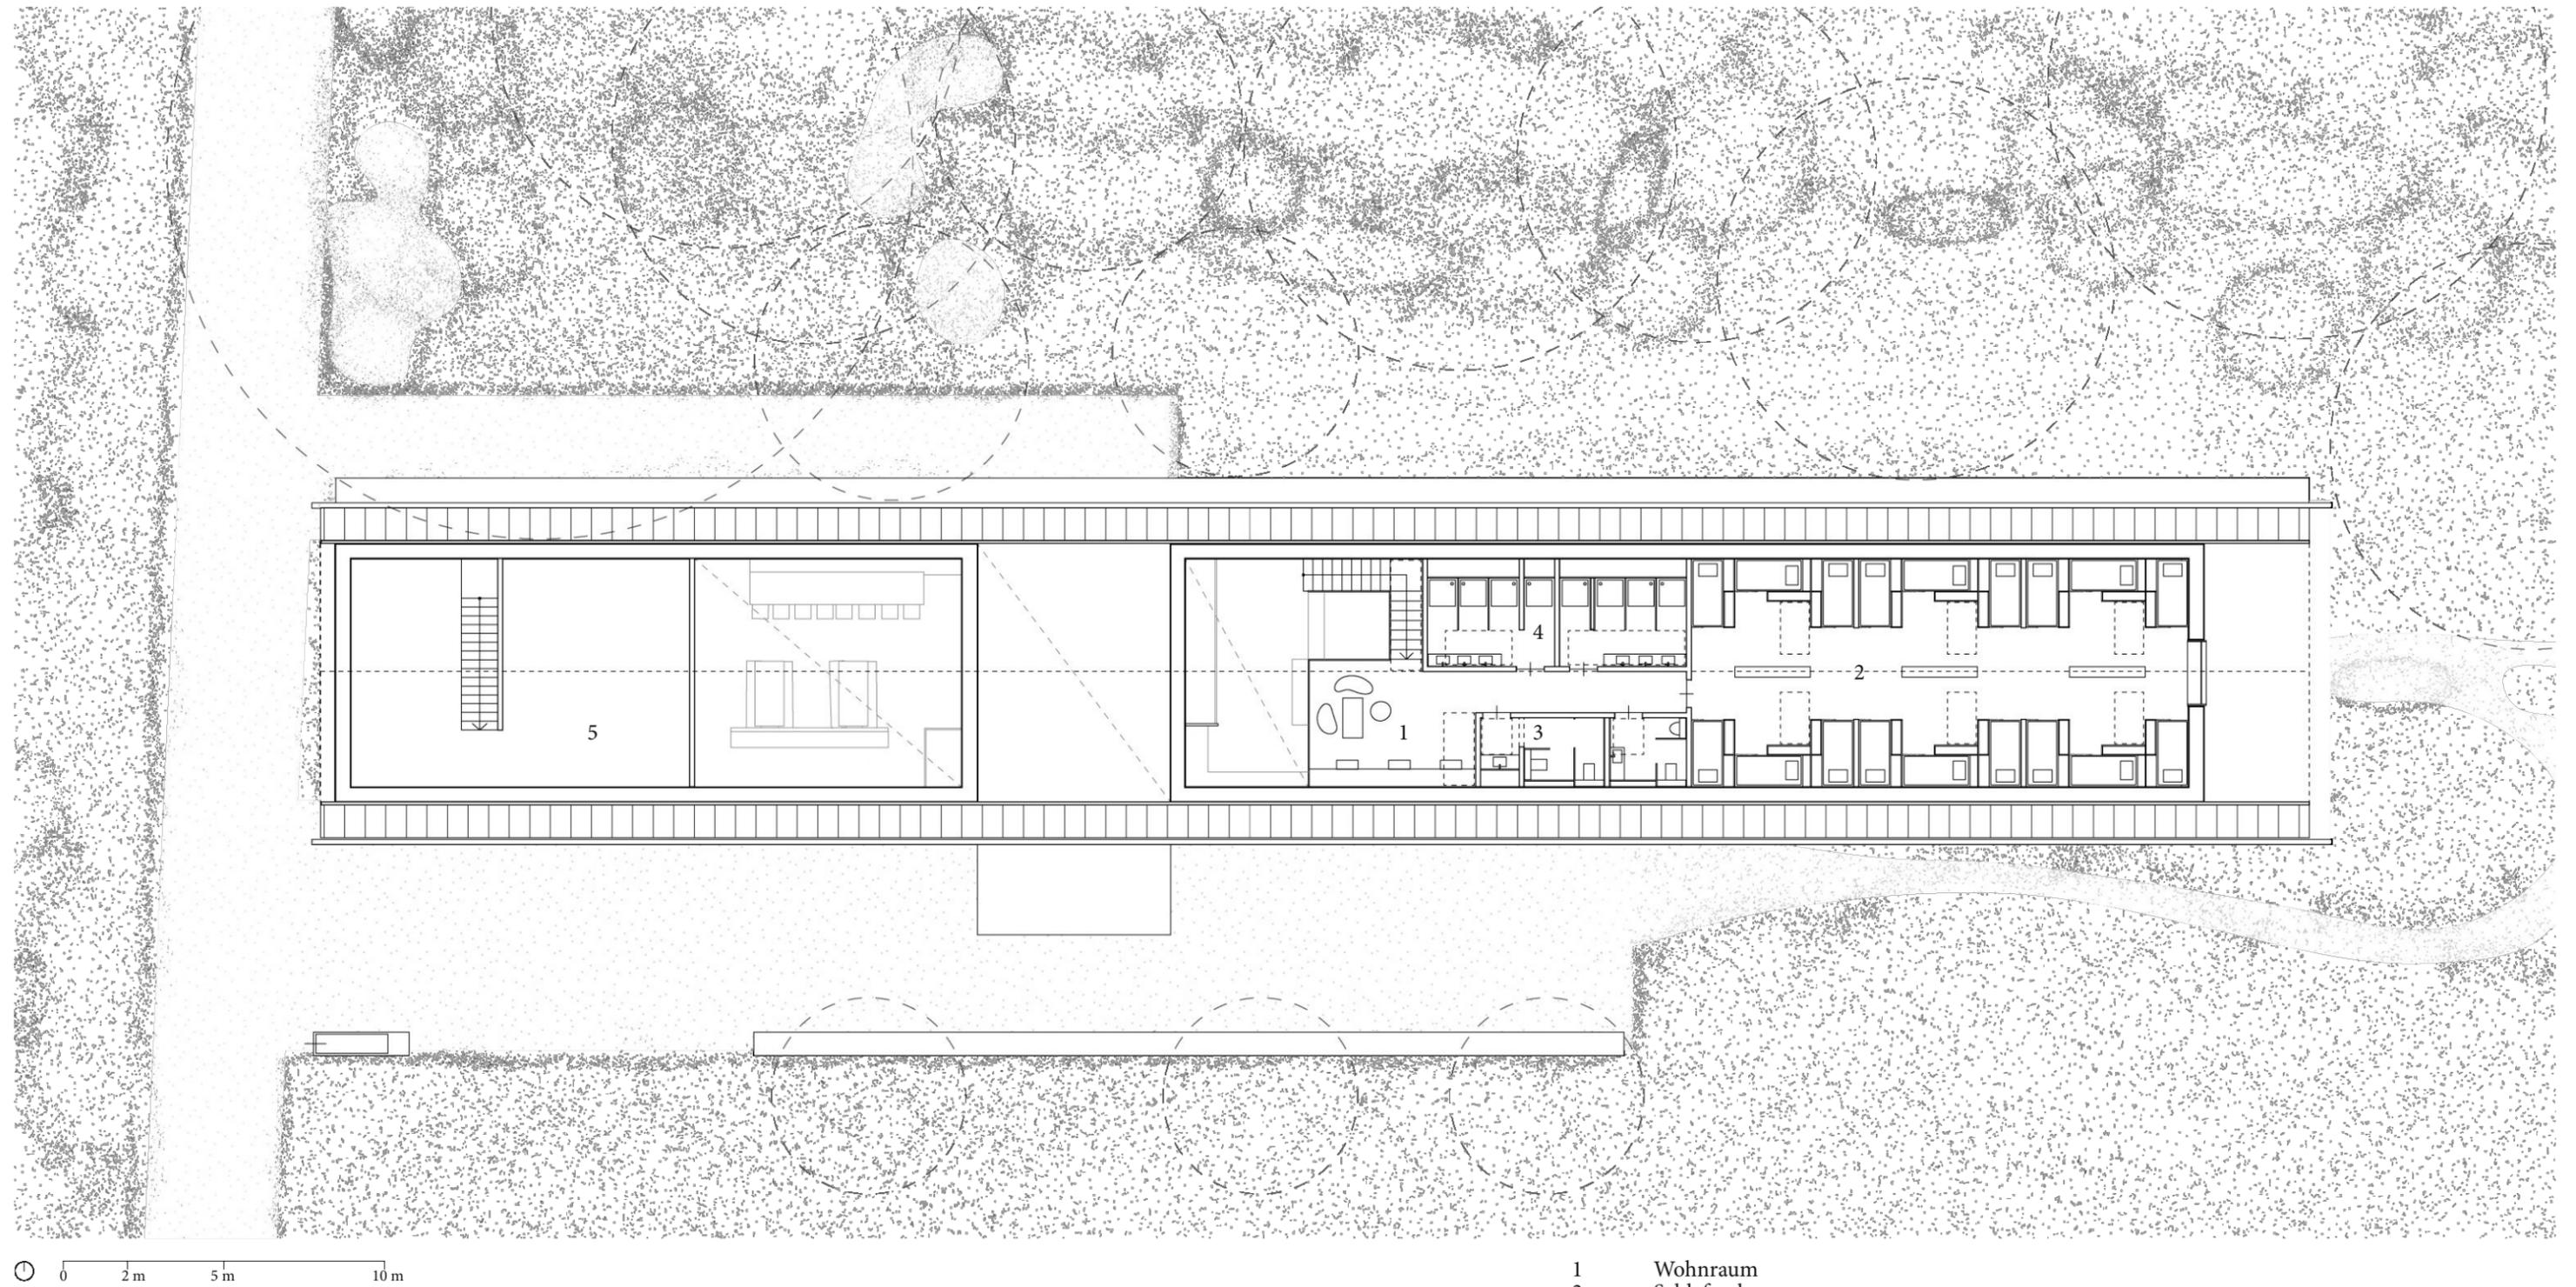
Grundriss Obergeschoss M 1:200
